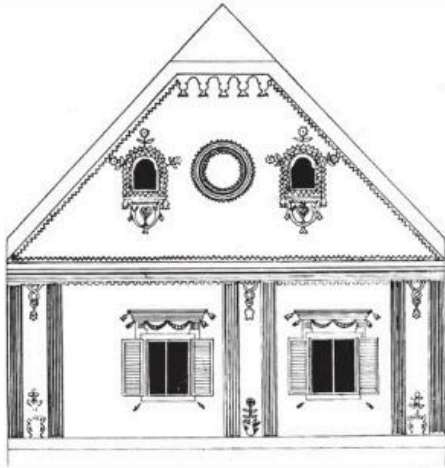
Bauernhaus Wolfau Nr. 112, Fassade;
